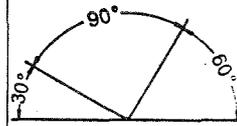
Winkelmaße Bild 38 Bemaßen von Rundmauerwerk
